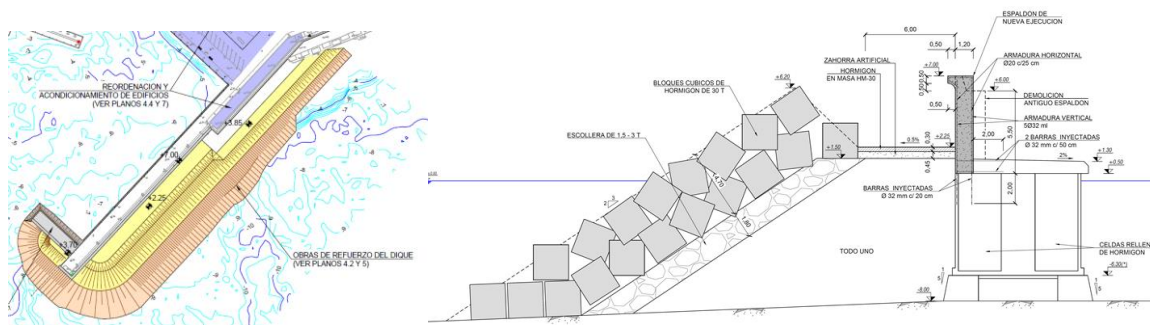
Planta y sección tipo del refuerzo del dique finalmente proyectado
